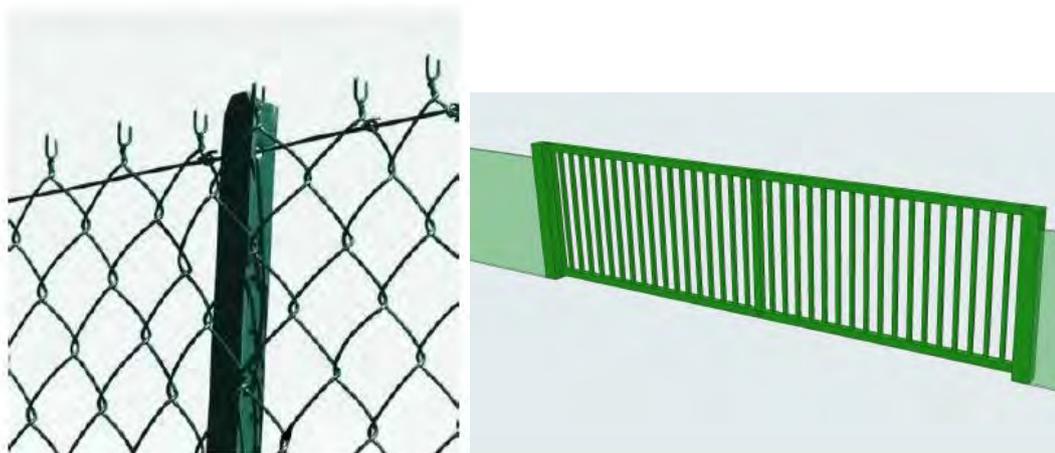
Exemple de clôture et de portail (Source : Architecte ARCAD)
